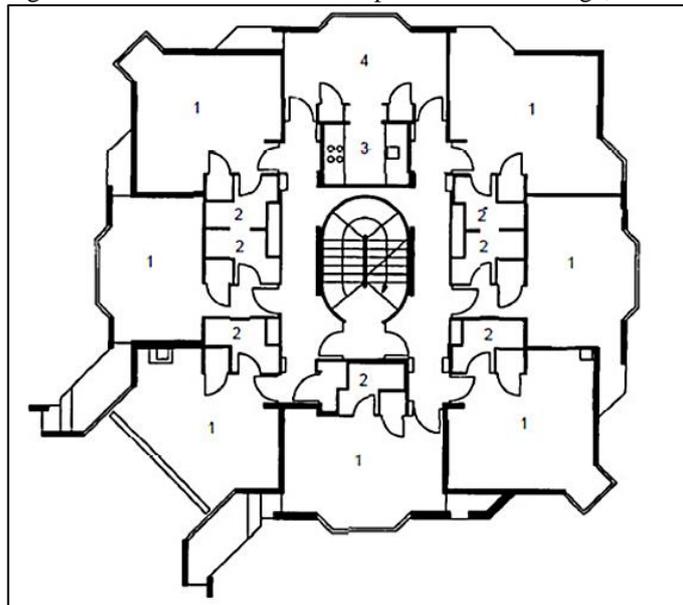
Planta do Pavimento Térreo do Balliol College, Reino Unido
